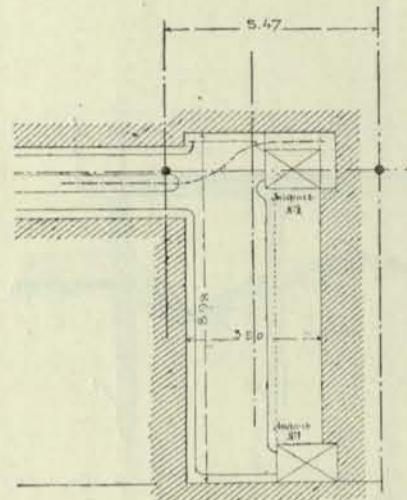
Планъ продольнаго багажнаго тоннеля.
